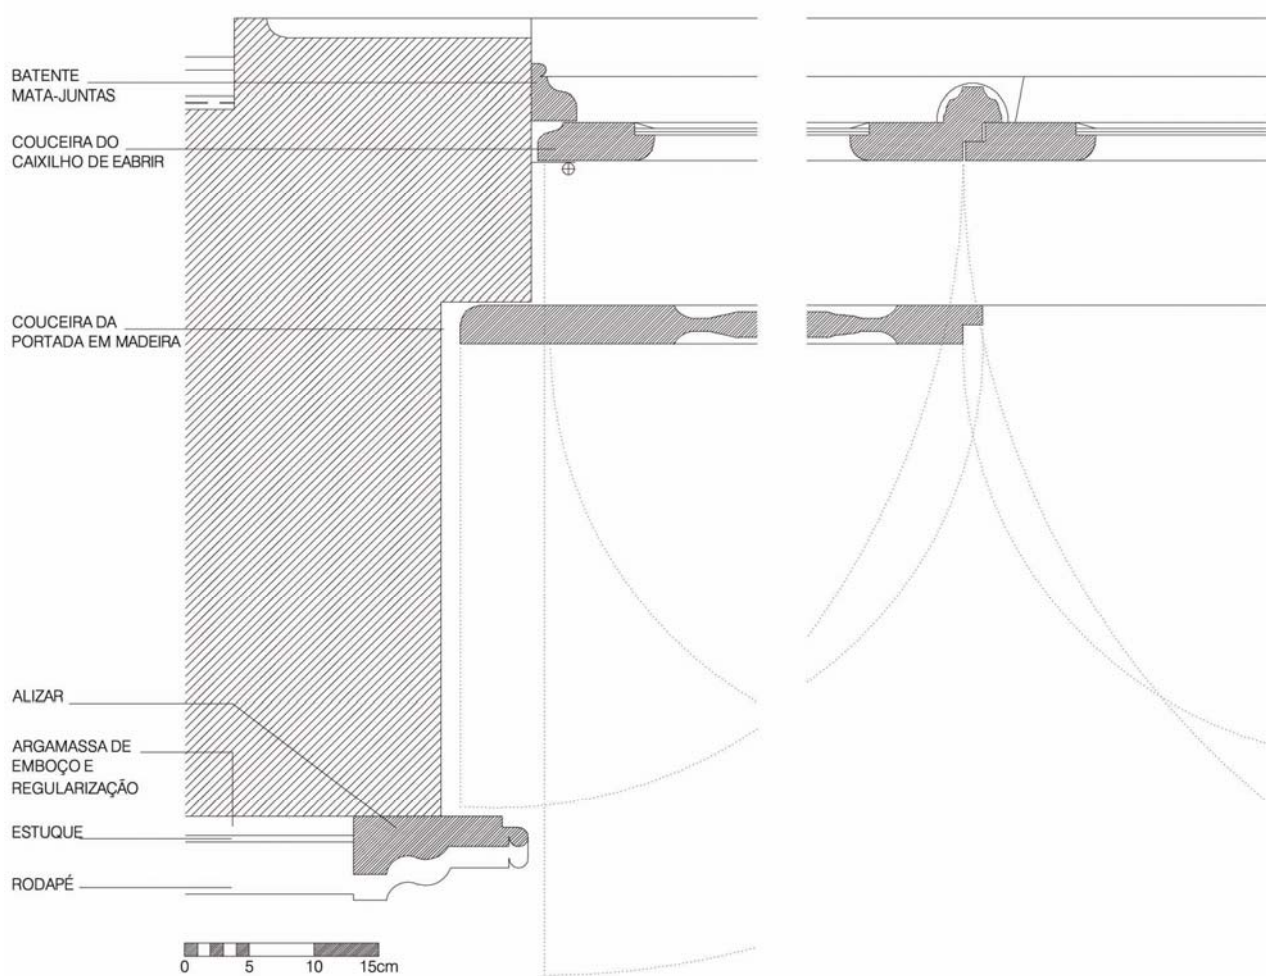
Janela de sacada e batente (duas folhas e bandeira fixa) - pormenor do corte horizontal.
